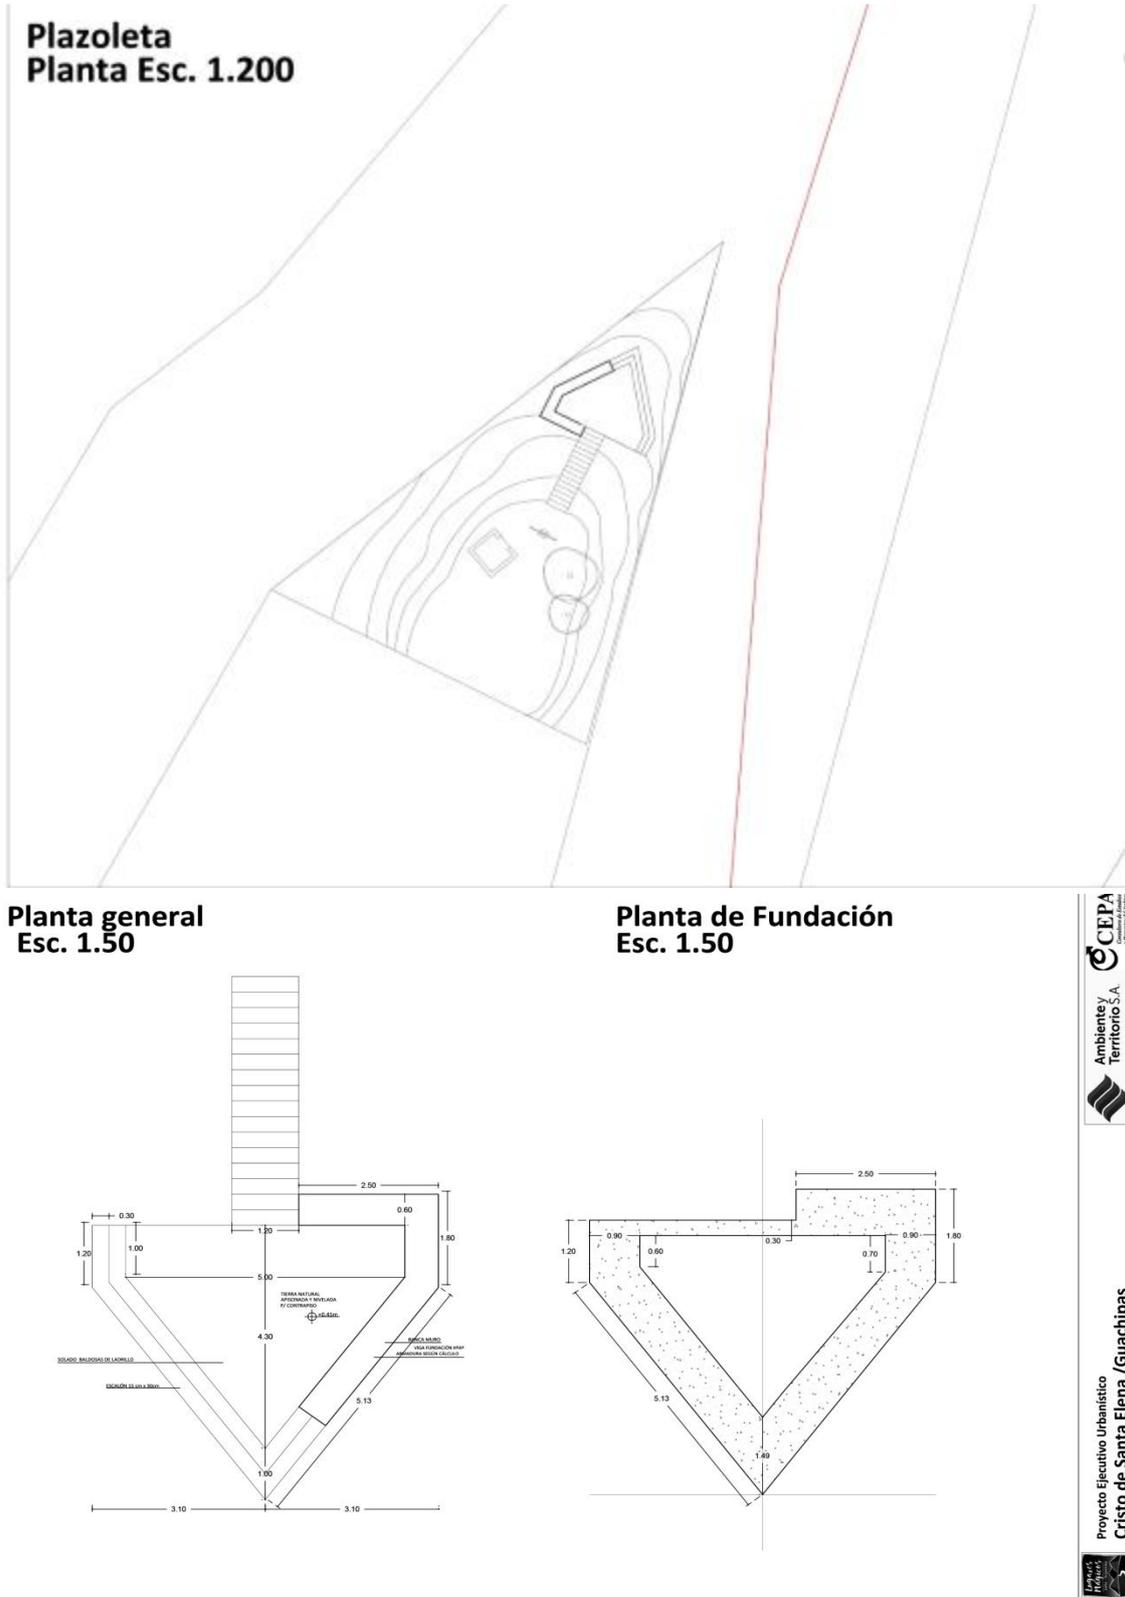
Planta plazoleta (arriba), planta general (abajo a la izquierda) y planta de fundación (abajo a la derecha)
